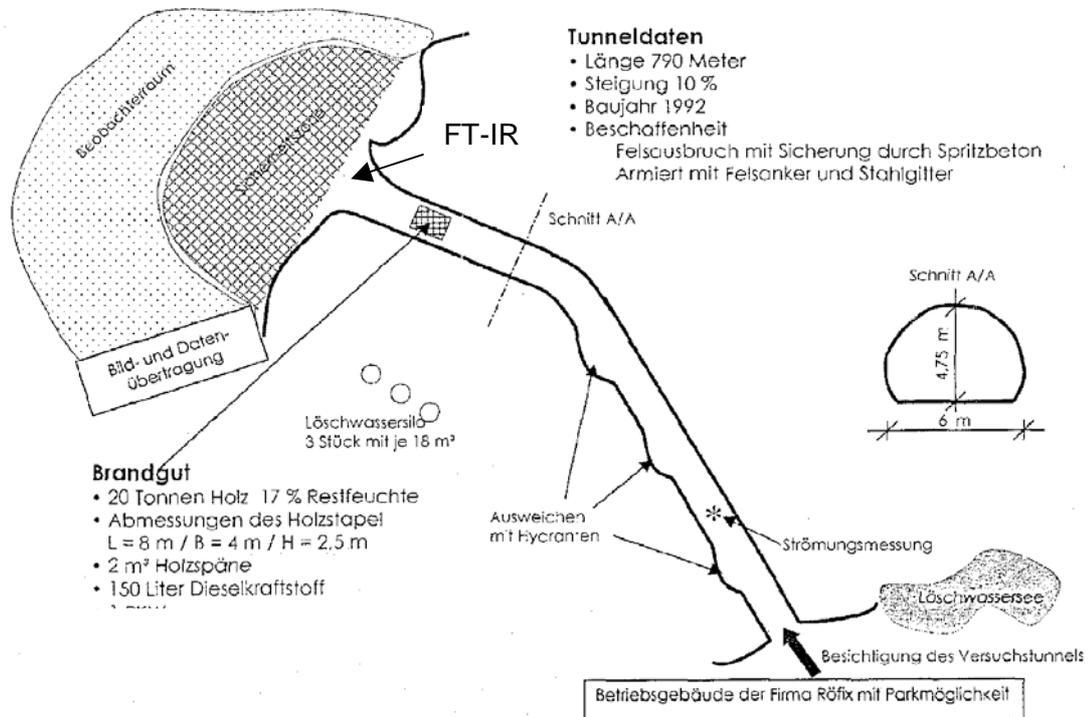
Ansicht der Tunnelanlage mit Tunneldaten, Brandgut und Messtechnik
